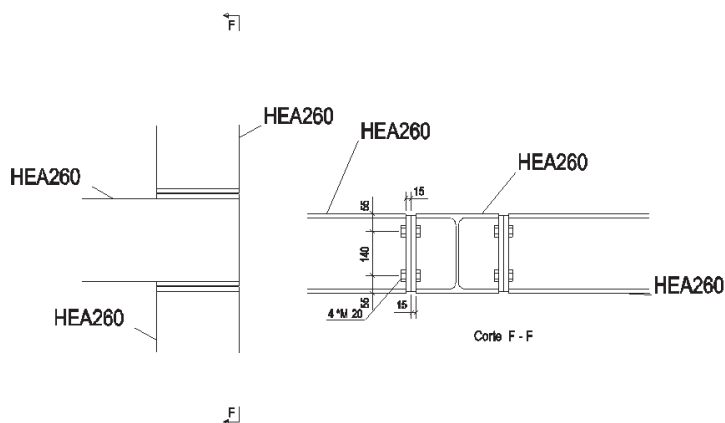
Proposta de alteração da ligação entre as vigas das palas.
